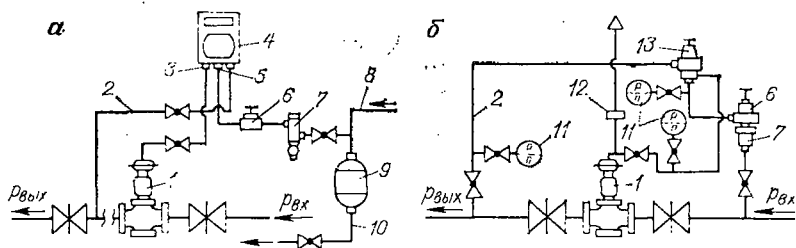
Схема обвязки клапана регулирующего с командным прибором. а — МТ-711Р (МТ-712Р); б — с пилотом ДПМ; 1 — клапан регулирующий; 2 — трубопровод контролируемого давления; 3 — штуцер «Выход»; 4 — прибор МТ-711Р (МТ-712Р); 5 — штуцер «Питание»; 6 — редуктор давления воздуха; 7 — фильтр; 8 — воздухопровод от компрессора; 9 — ресивер; 10 — дренажный трубопровод; 11 — манометр; 12 — дроссель; 13 — пилот.
